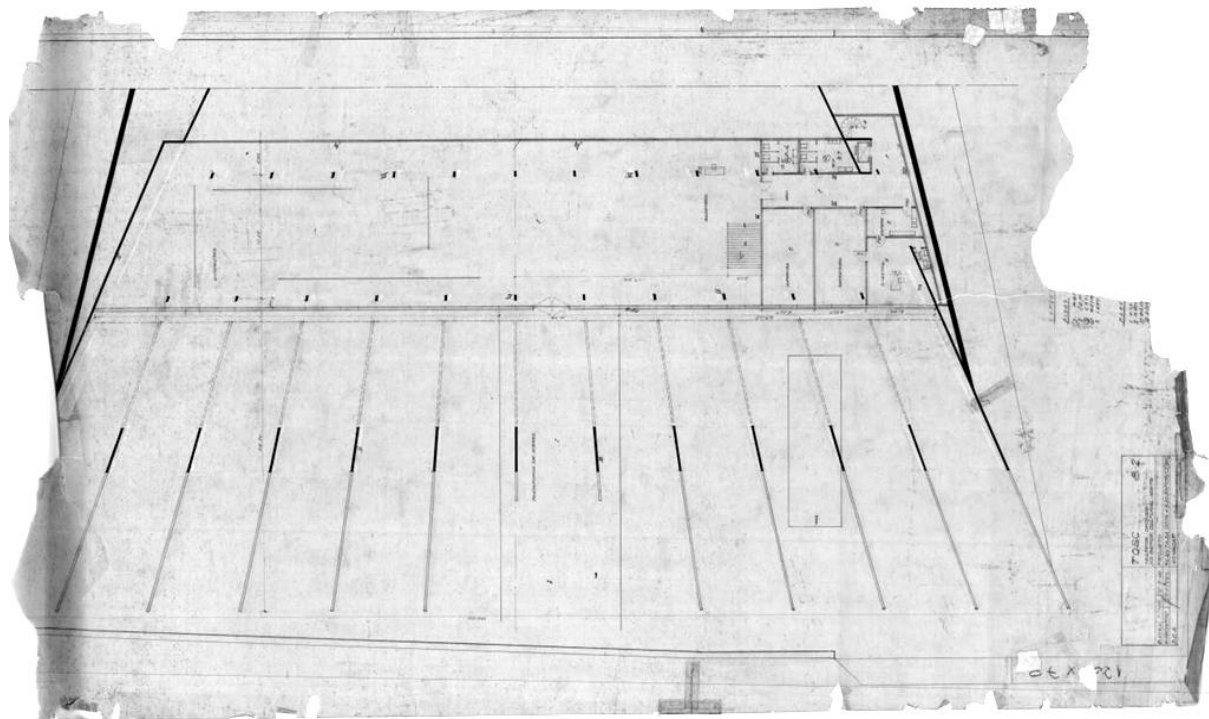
Planta Baixa/Detail - 1º Pavimento (1960). Carimbo: Teatros Oficiais no Setor Cultural Norte, TOSC, 8.2, NOVACAP. Conteúdo Planta da cota +3,30 (Exposições). Data: 12/03/1960. Fonte: ARPFD.
